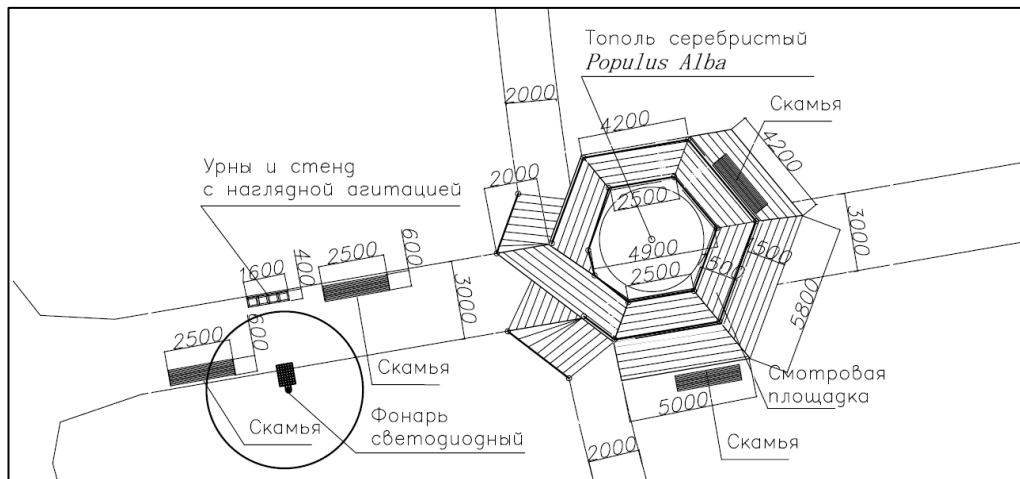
Фрагмент генплана 13, смотровая площадка
